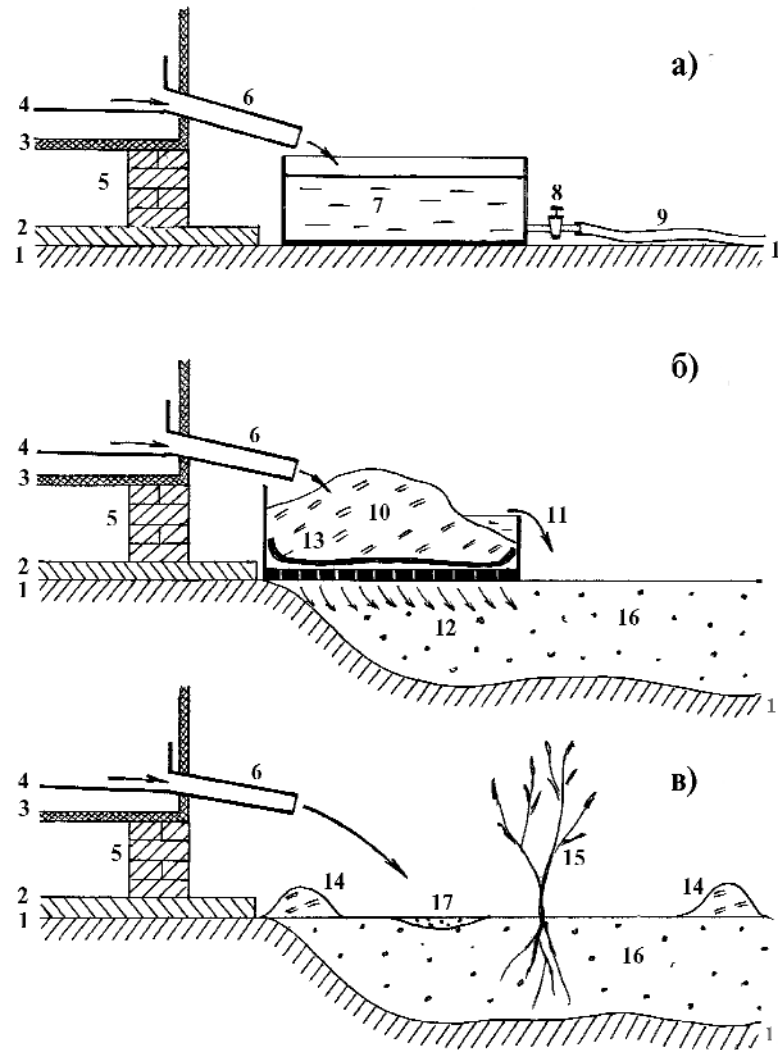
Схемы сбора и обработки стоков бани, сауны, душа на садовом и дачном участке: а – ассенизационная схема, б – схема компостирования, в – схема прямого сброса в фильтровальную траншею. 1 – грунт (почва), 2 – бетонная плита фундамента, 3 – ограждающие конструкции бани (полы, стены), 4 – поддон банный, 5 – цокольные столбики, 6 – сливной выпуск из
